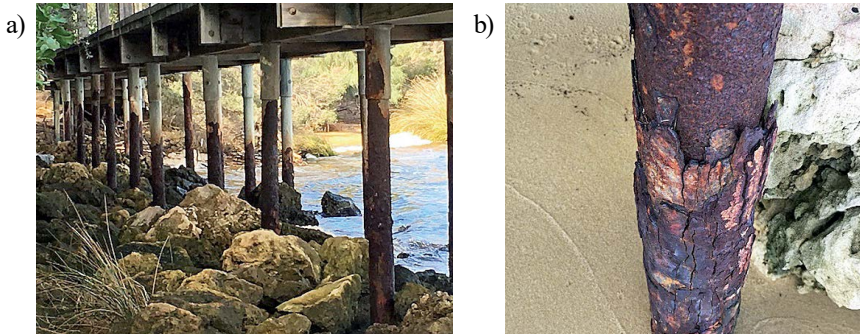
Przykład korozyjnej destrukcji zbrojenia słupa żelbetowego wspierającego konstrukcję wiaduktu. Za zgodą z [38]
